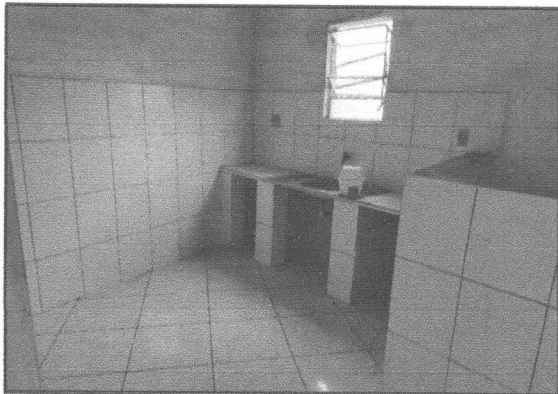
Cozinha pavimento superior, com revestimento cerâmico em piso e paredes
